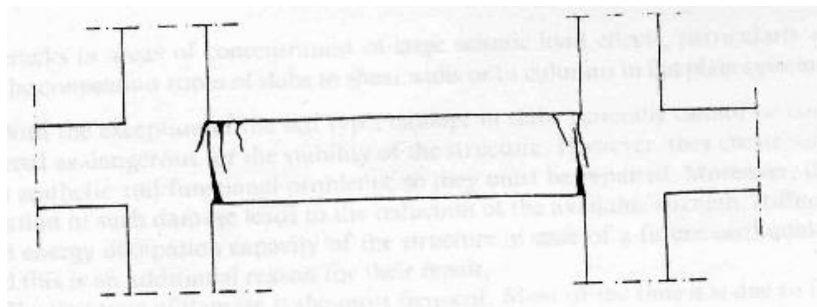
Fissures de Flexion sur la face supérieure ou inférieure aux appuis de la poutre [2].
